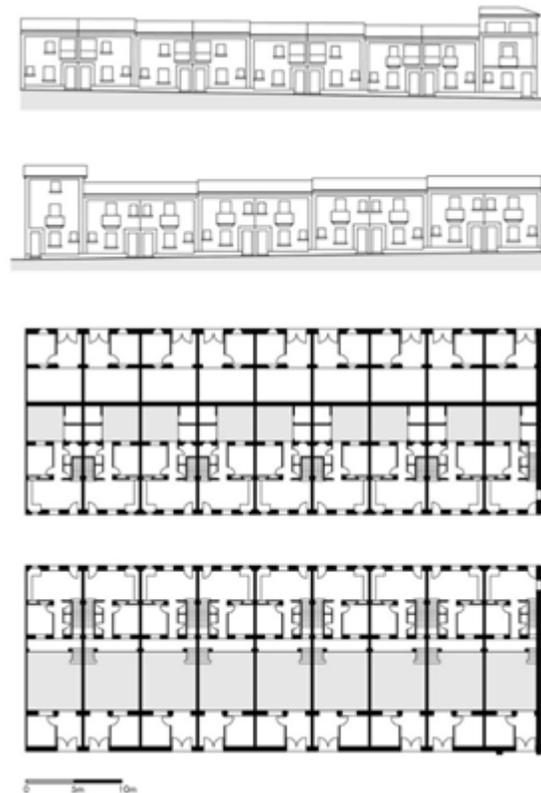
Alzado y planta de Manzana de viviendas para labrador en Viver
